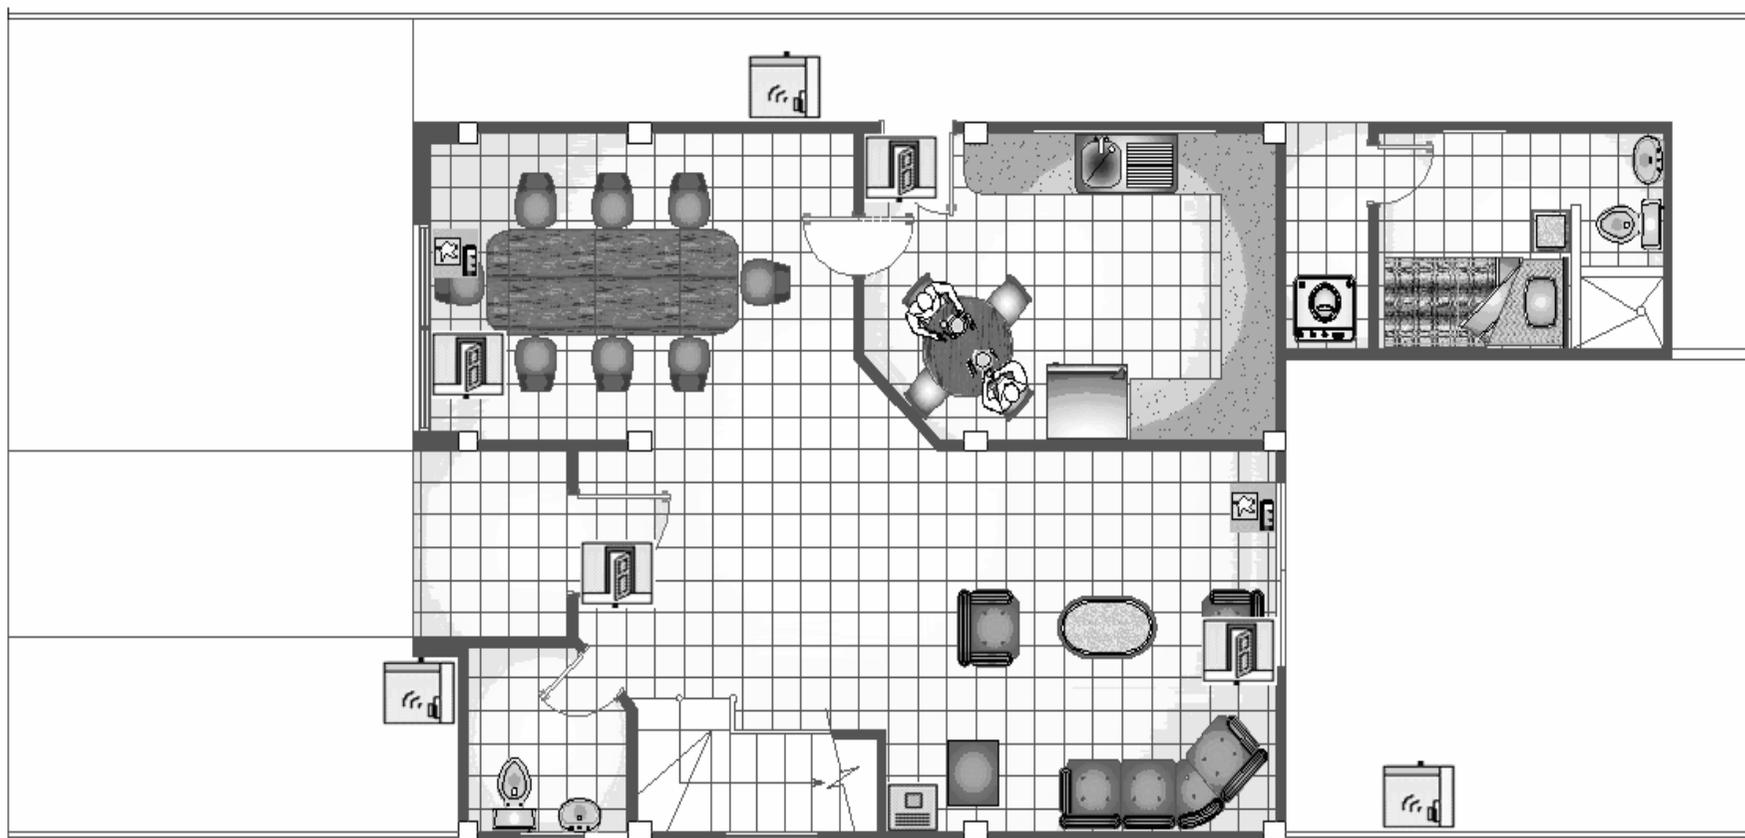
Sistema de Seguridad frente a intrusos, Planta Baja, Plano Arquitectónico.
